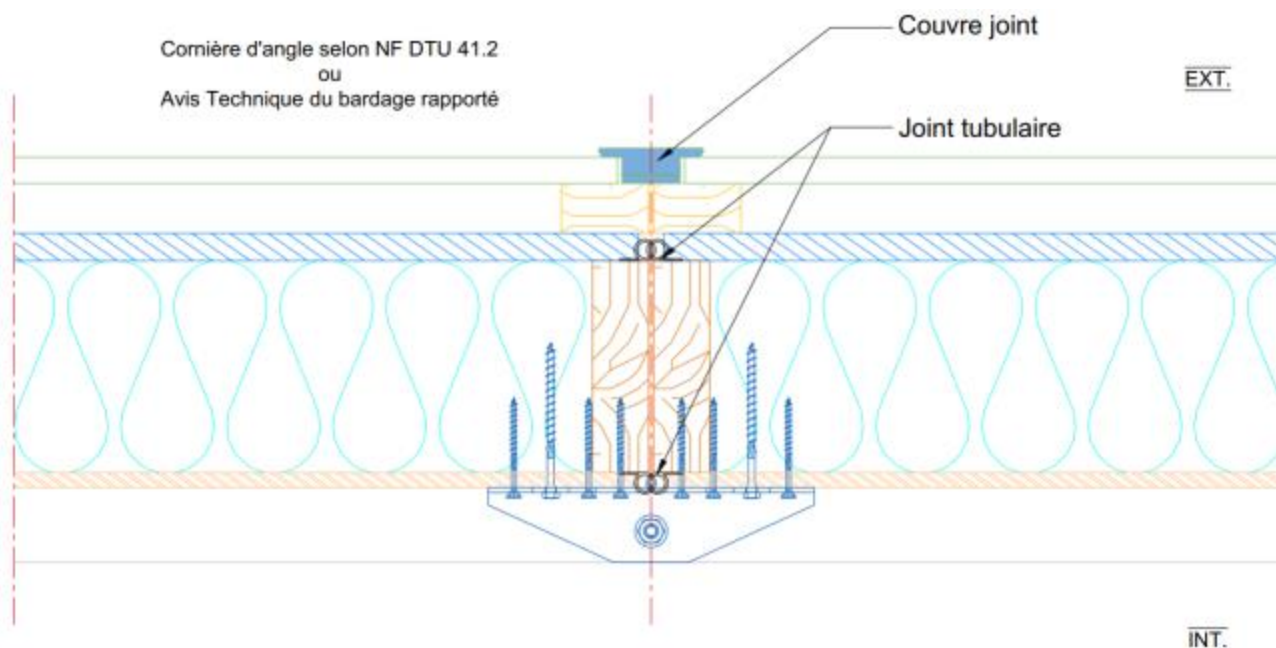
Assemblage des panneaux SYBOIS MUR – Fixation courante – Coupe horizontale
